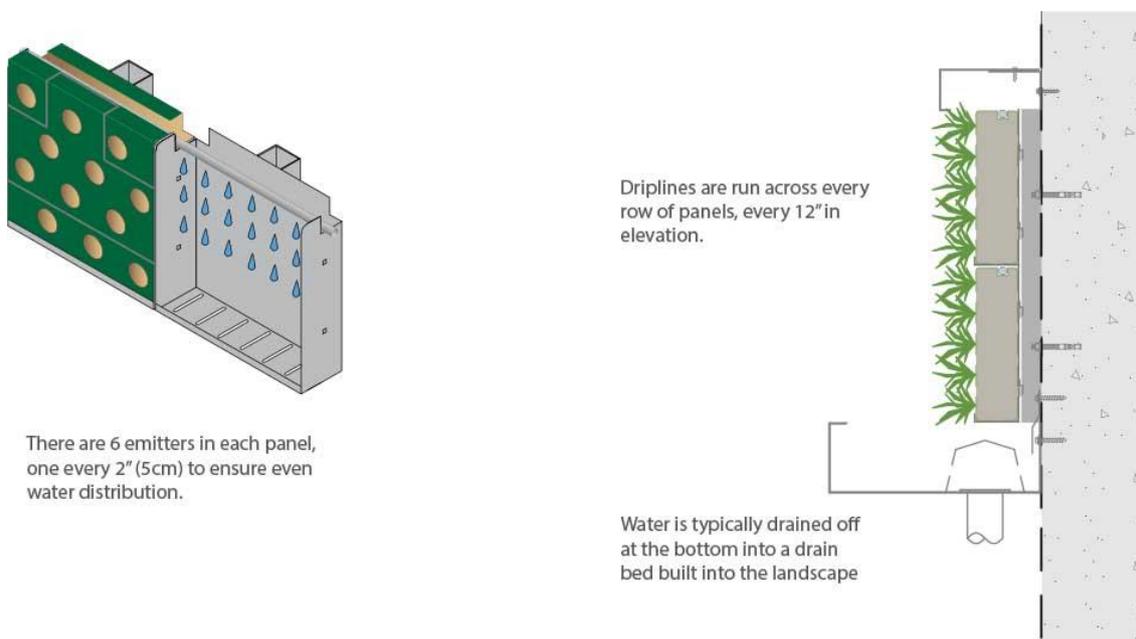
Sistema pré-fabricado Pro Wall da empresa norte americana Gsky plant systems
